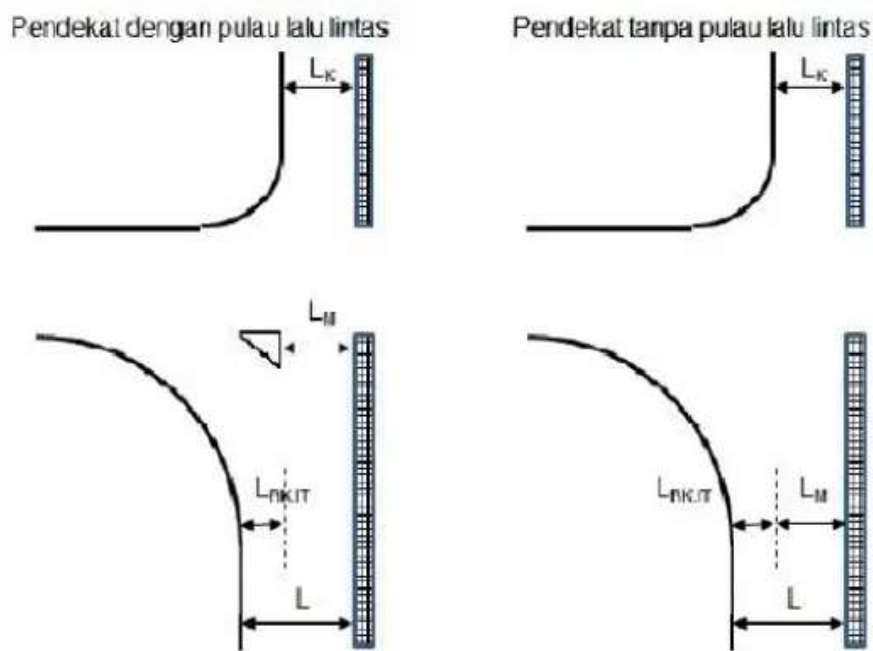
Penentuan Tipe Pendekat (PKJI, 2014)
